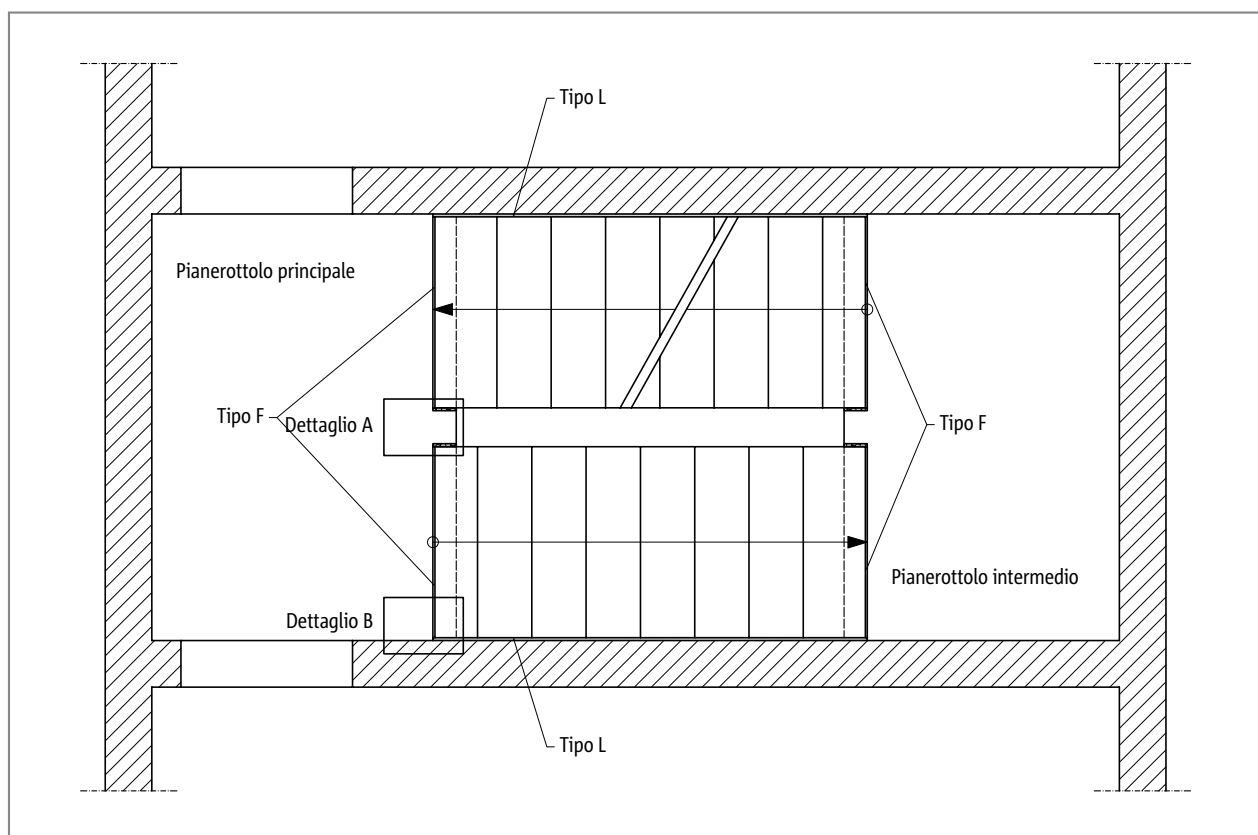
Schöck Tronsole® tipo F, disposizione dell'elemento in pianta
